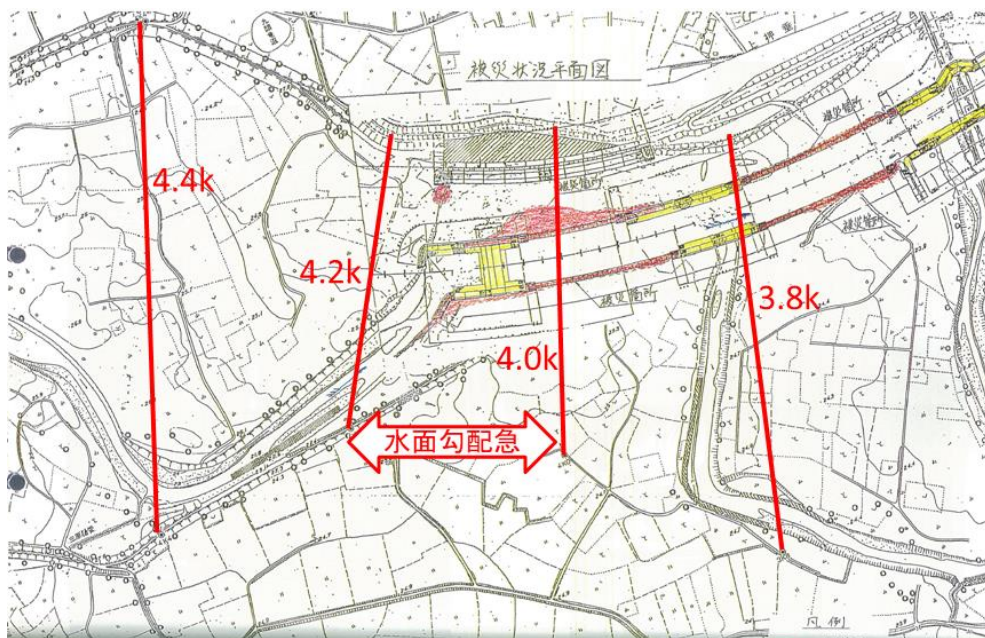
都幾川 H3.8 洪水 護岸被災顕著な区間平面図
